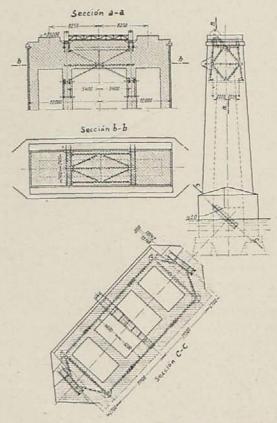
Pila y construcciones metálicas para el anclaje de las consolas auxiliares.
